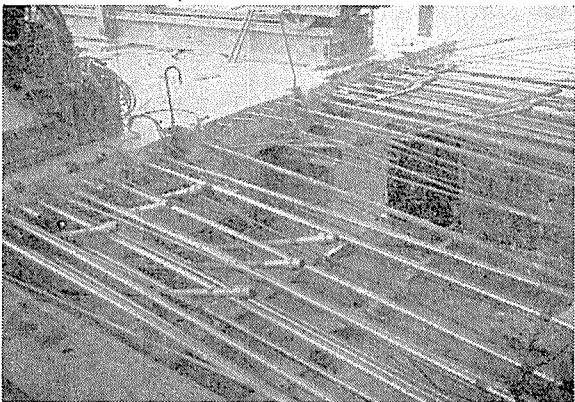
同じく吊鋼棒定着側アンカー（両主桁で18本）
